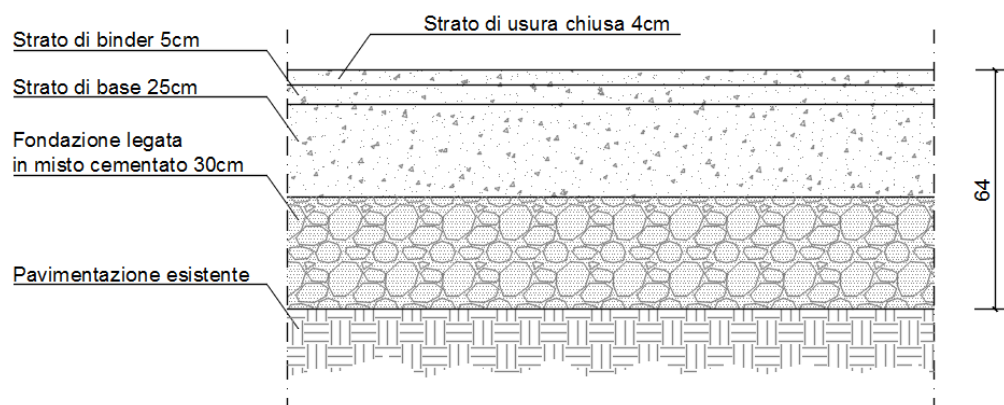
Pacchetto di ripristino pavimentazione rampe di svincolo TIPO P5B
